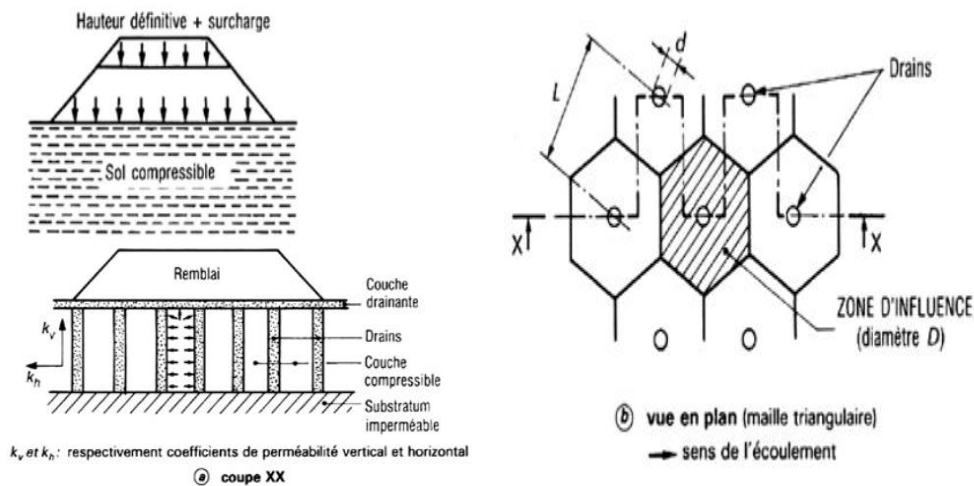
réseaux de drains verticaux(Magnan J.P.& pilot, G.1988).
